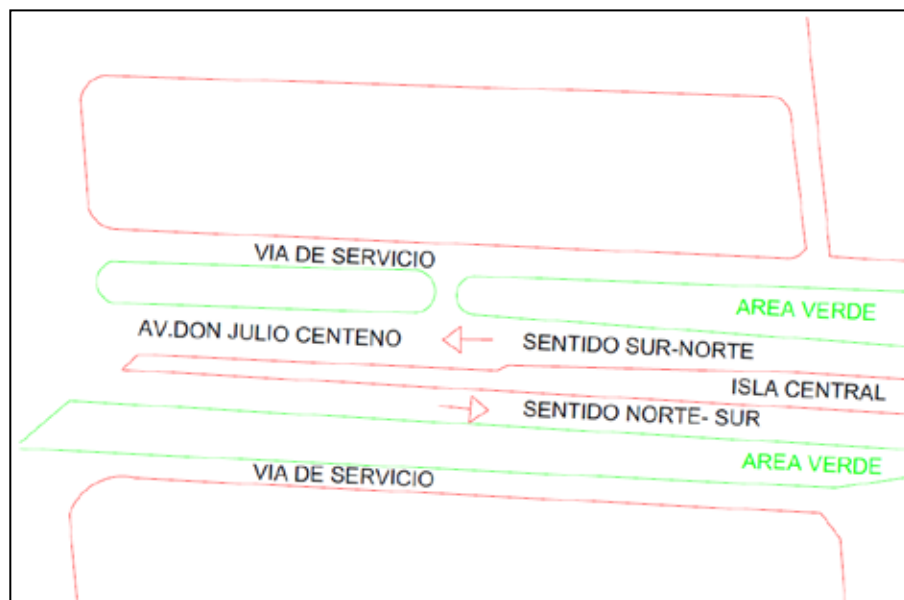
Planta tipo ancho de canales Av. Don Julio Centeno
